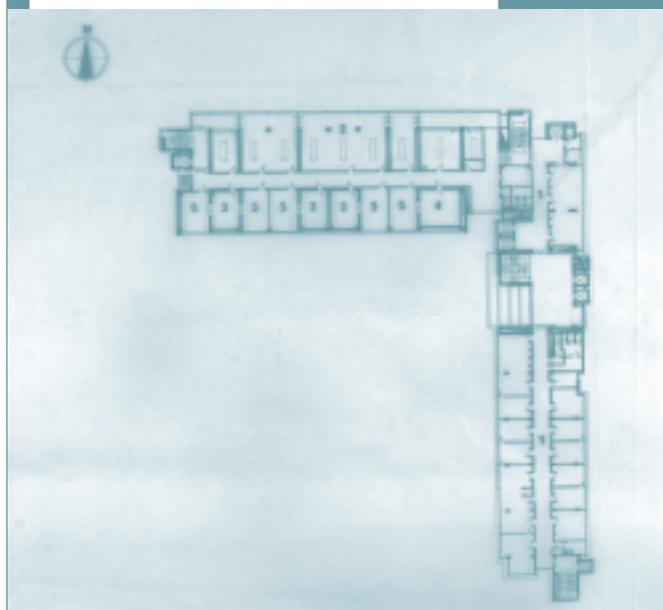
Planimetria del piano secondo della Zona radio e del piano terzo della Zona uffici (ASF)
